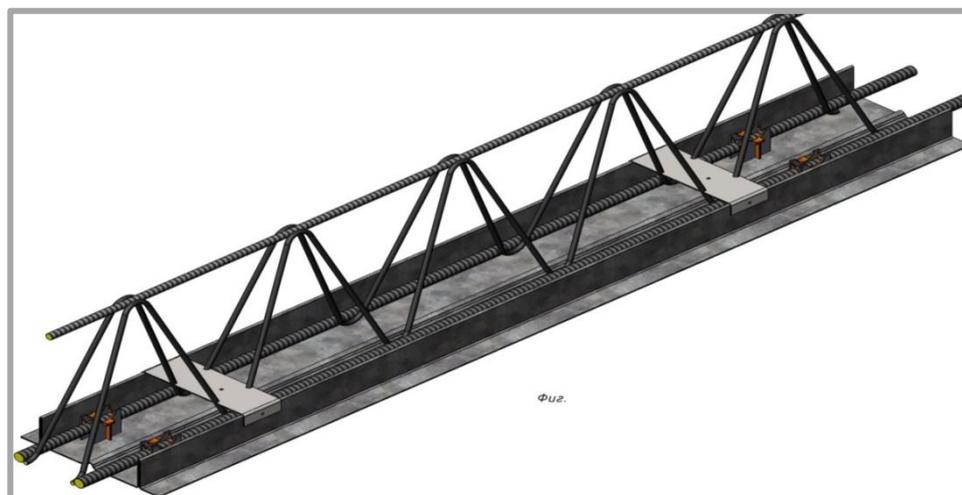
Тонкостенная балка перекрытия «МАРКО-УНИВЕРСАЛ» [1]
